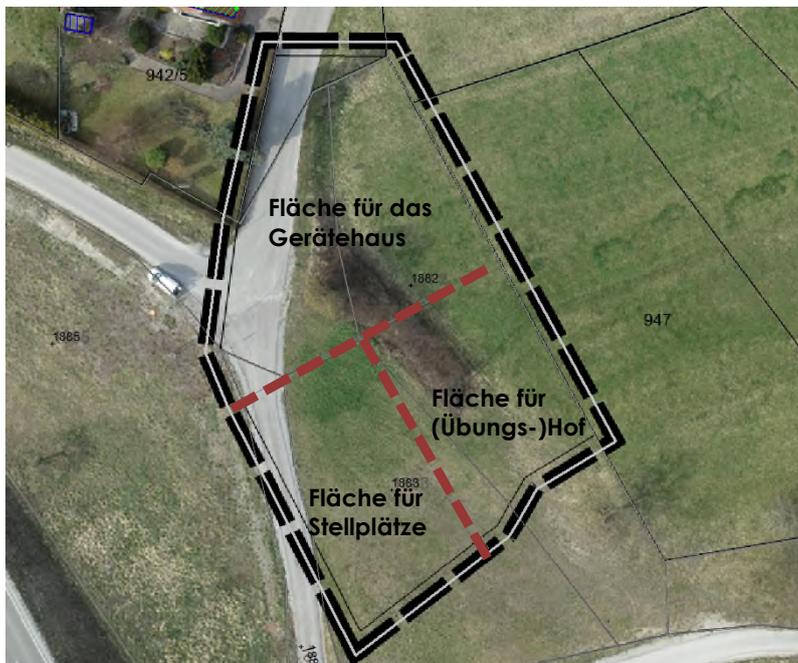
Abgrenzungsplan zum Bebauungsplan ‚Feuerwache Westgartshausen‘ [18]
